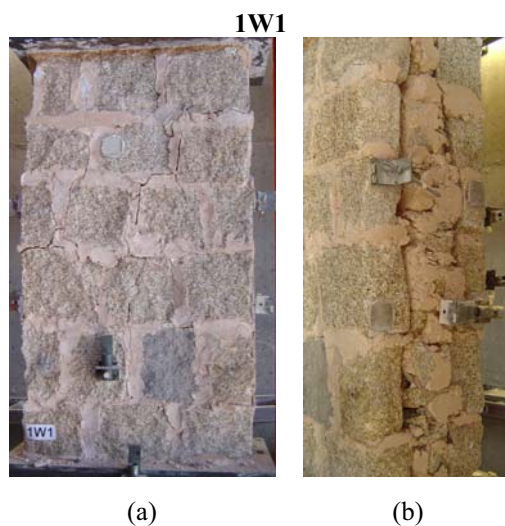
Padrão de fendilhação da parede 1W1 no final do ensaio: (a) face B; (b) face C.
